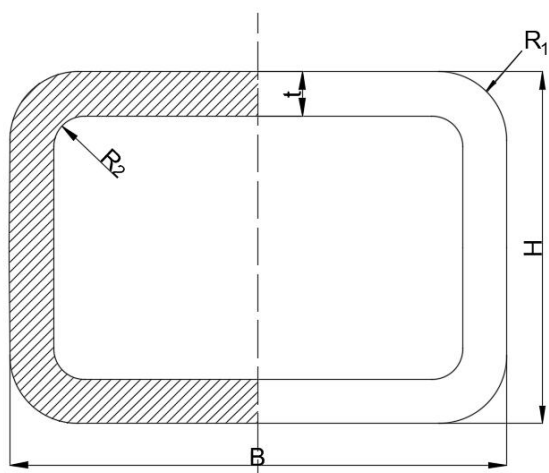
钢筋混凝土顶管矩形管节外型图
